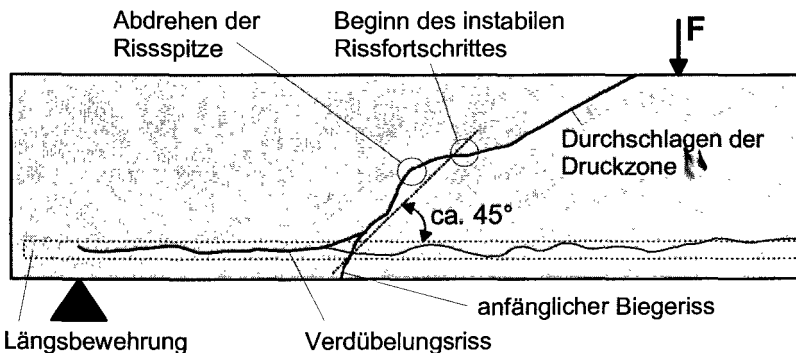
Biegeschubversagen von Balken ohne Schubbewehrung [105]
